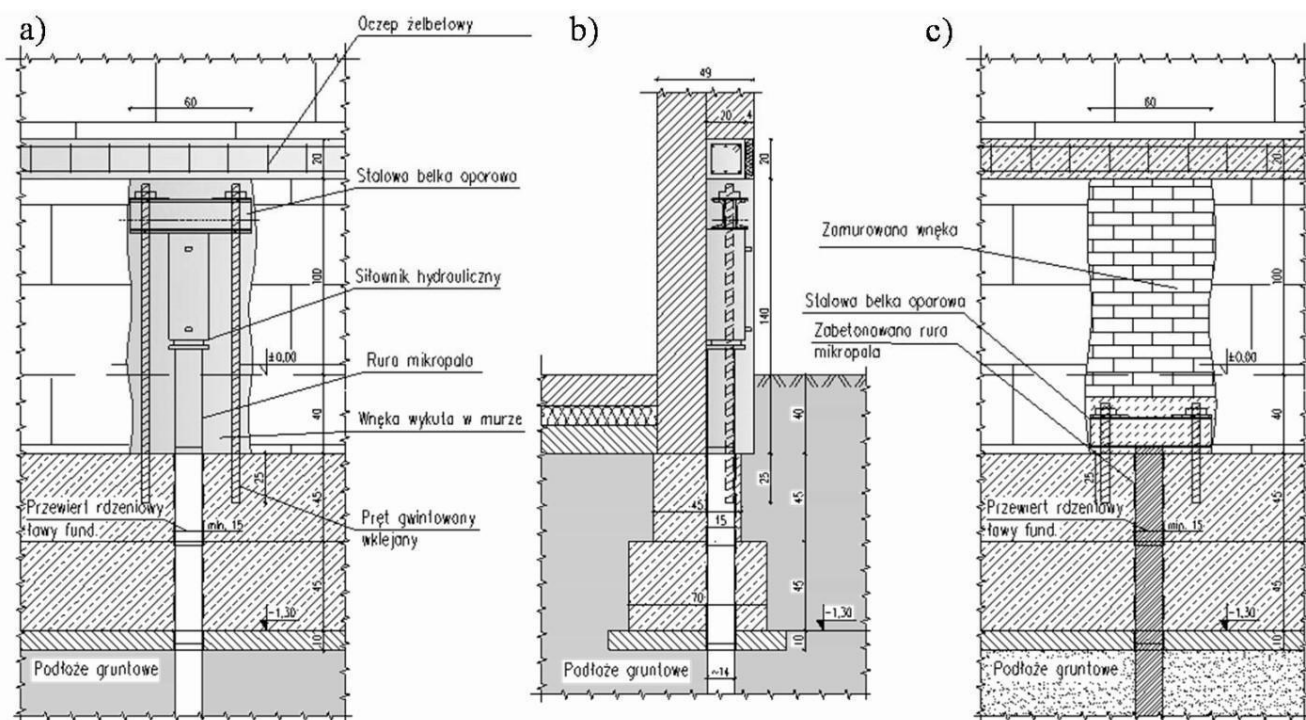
Схема підсилення фундаментів: а) схема виконання підсилення фундаментної стрічки; б) розріз по фундаментній стрічці; в) фронтальний вигляд фундаментної стрічки після виконання підсилення.[40]
